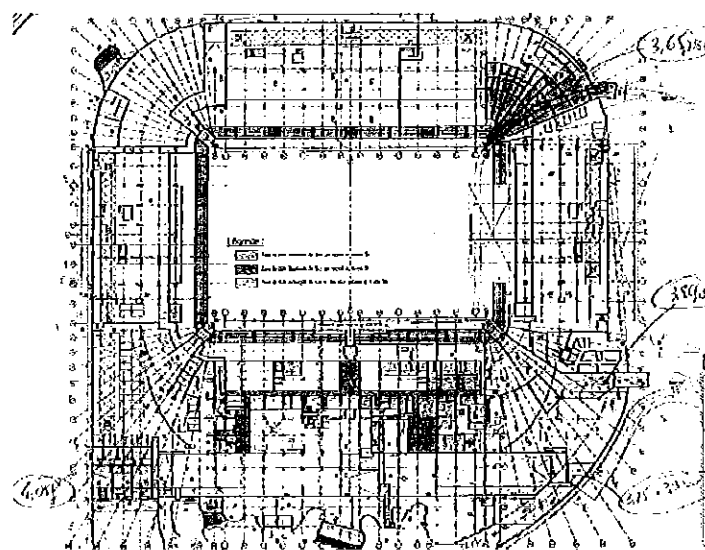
Repérage des dalles basses concernées par la pression hydrostatique sur fond de plan masse
